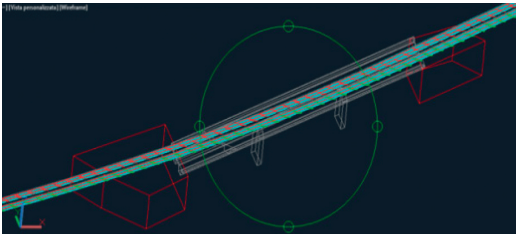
Costruzione del cavalcavia A2 e delle spalle.
